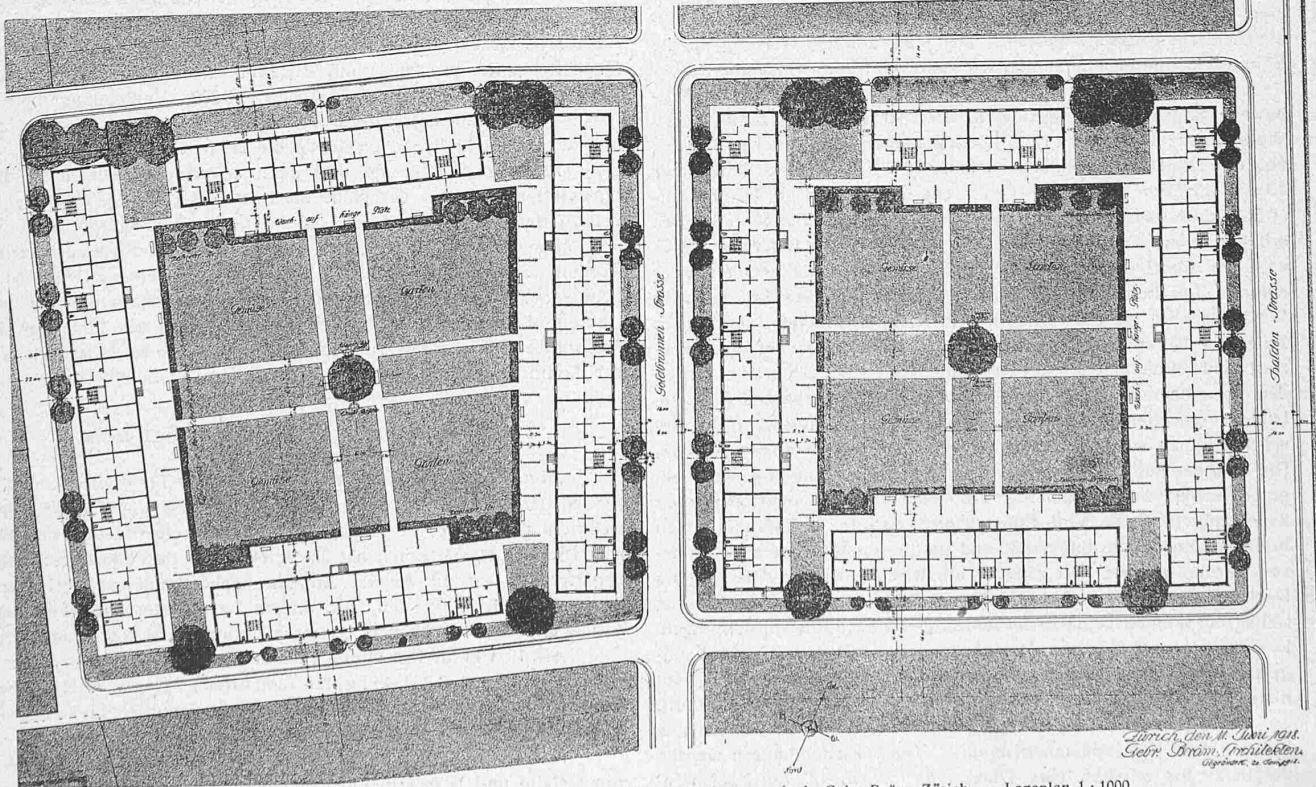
Wohnhäuser-Gruppe auf dem „Rebhügel“ in Zürich-Wiedikon. — Arch. Gebr. Bräm, Zürich. — Lageplan 1 : 1000.
